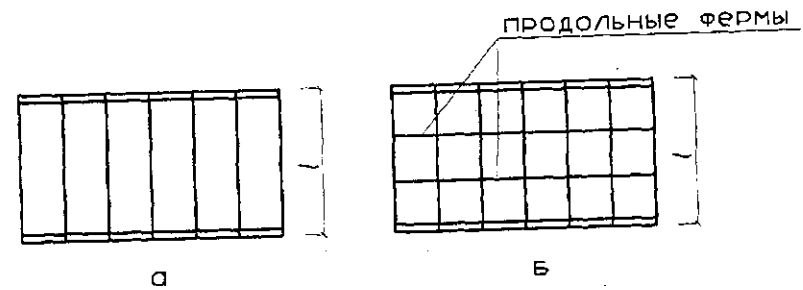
Схема ферм покрытия: а — поперечные фермы; б — поперечные и продольные фермы
